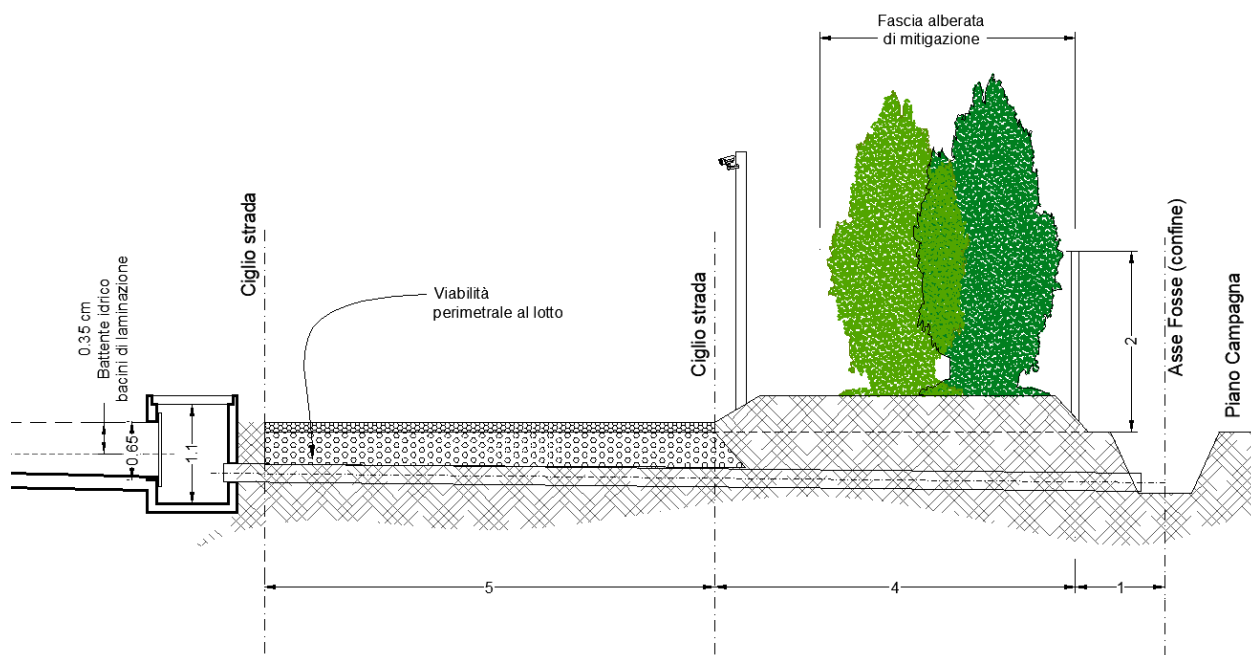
SEZIONE TIPO STRADA PERIMETRALE CON MITIGAZIONE, FOSSE DI GUARDIA
